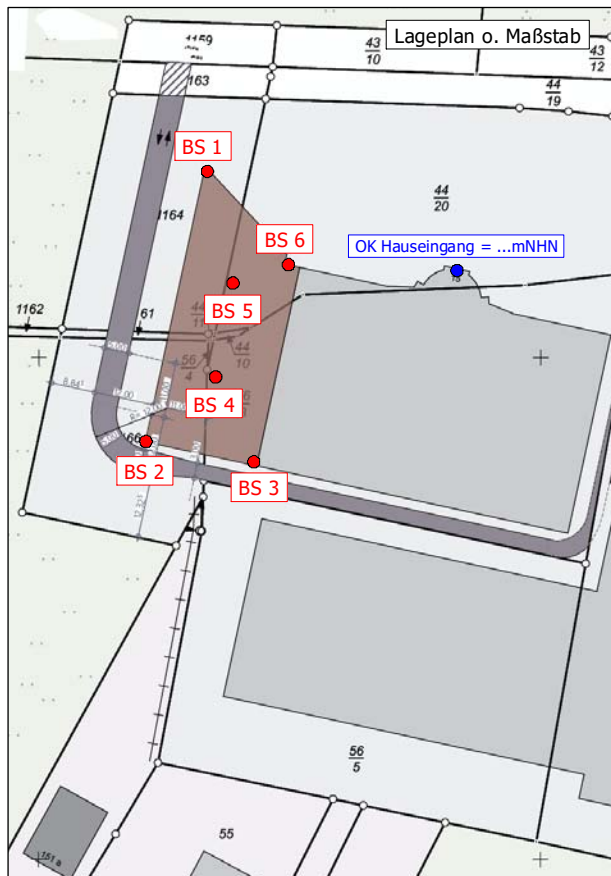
Lageplan s. Anl. 1.1 (o. M.)
